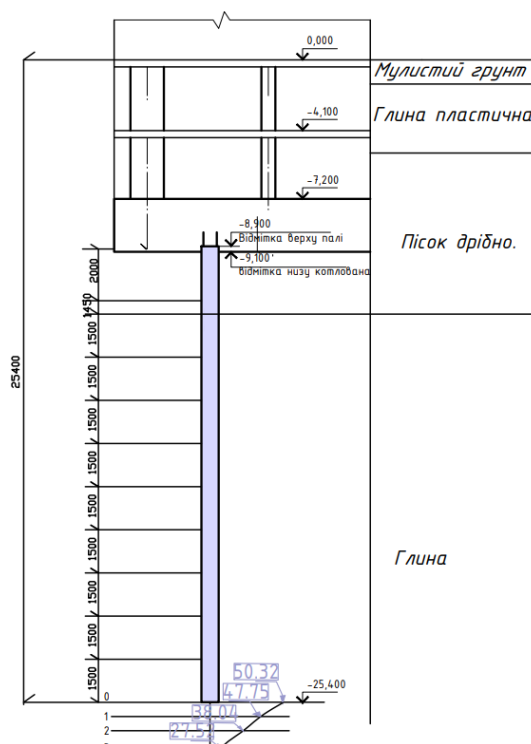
Осідання ґрунту під умовним фундаментом
